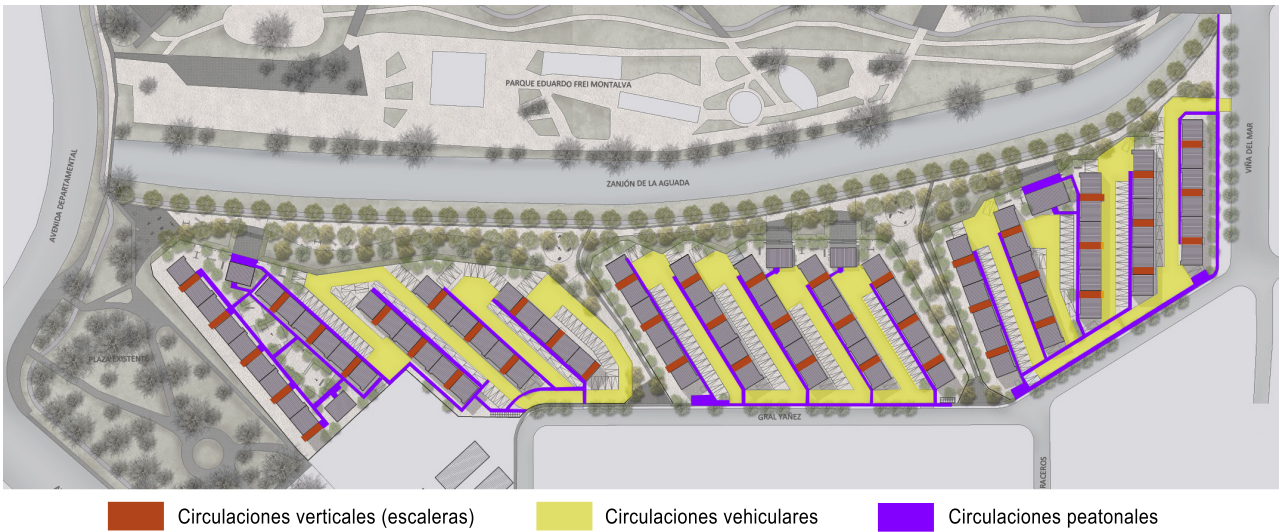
Esquema Circulaciones Proyecto Portal La Florida. Elaboración propia en base a planimetrías.
